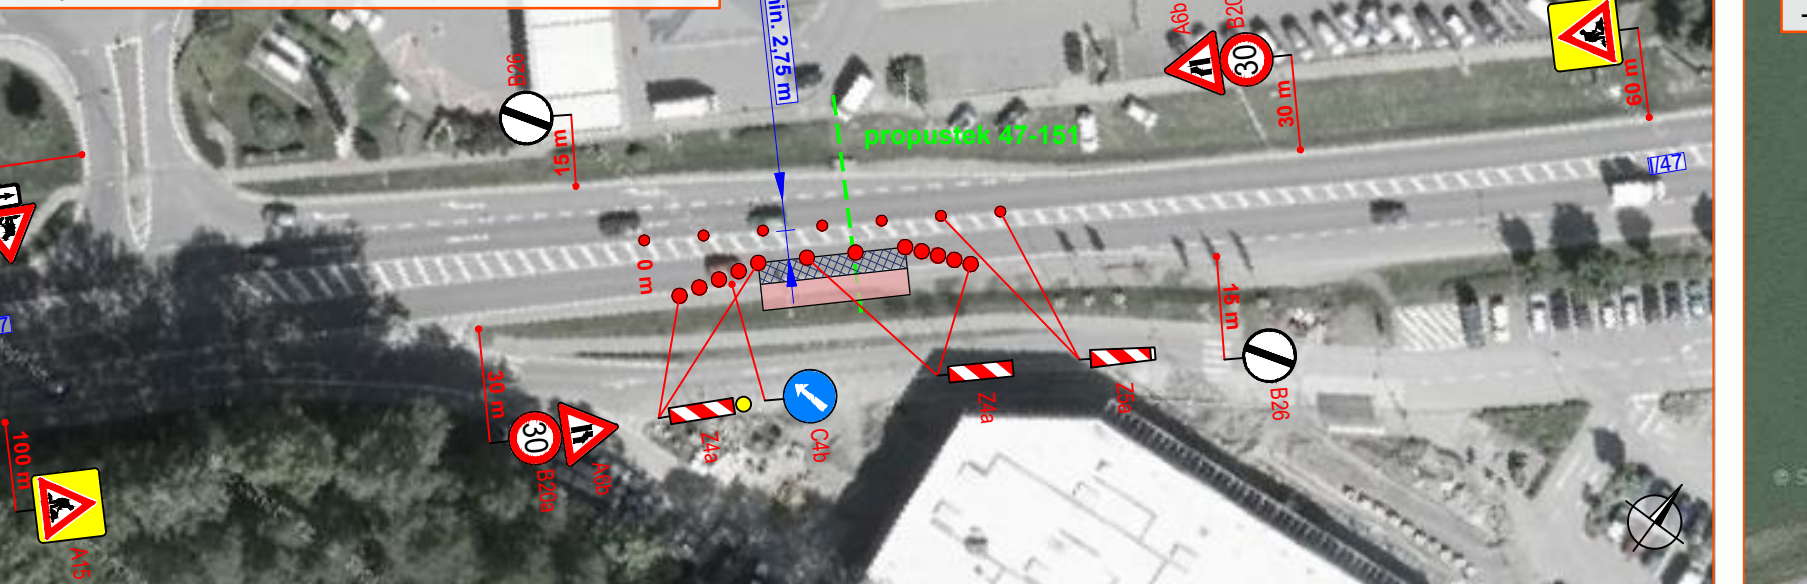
LEVÝ JÍZDNÍ PÁS
